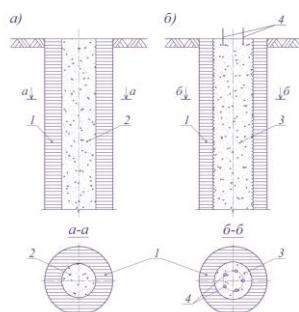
Схема устройства грунтобетонной сваи (ГБС)
